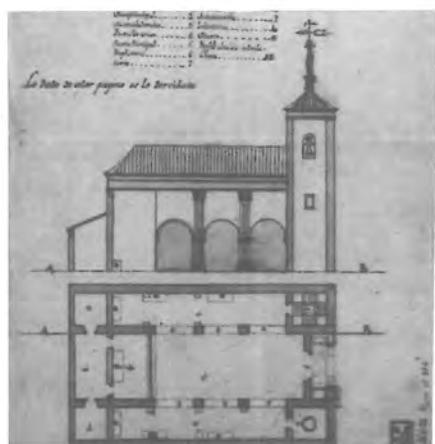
GENALGUACIL: Planta y alzado de la parroquia realizados en 1774 por Felipe Pérez.
